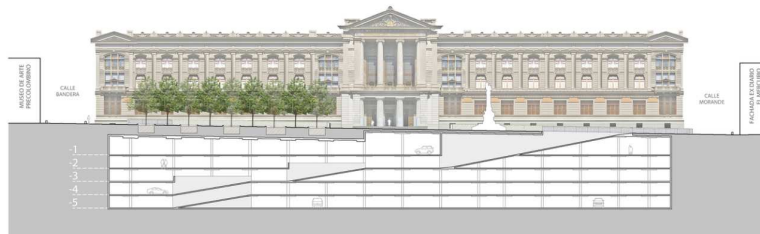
Sección de área de sótanos bajo la plaza. Fuente: Plano PLAN Arquitectos, 2015. Publicada en Plataforma Arquitectura.
